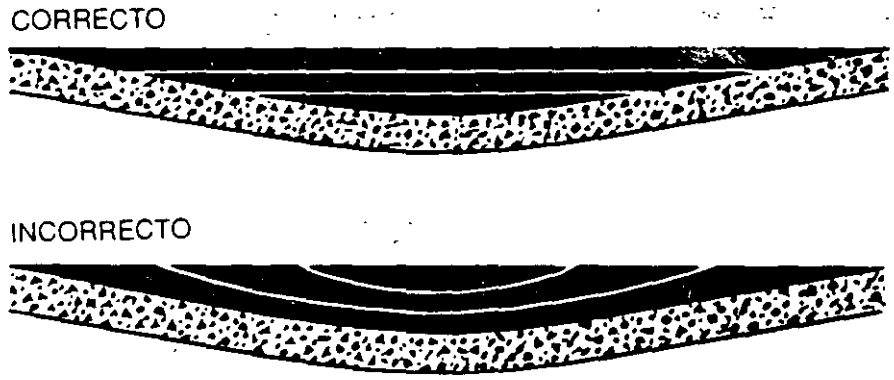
Una Colocación Correcta de Capas de Enrase Garantiza un Pavimento Liso.
